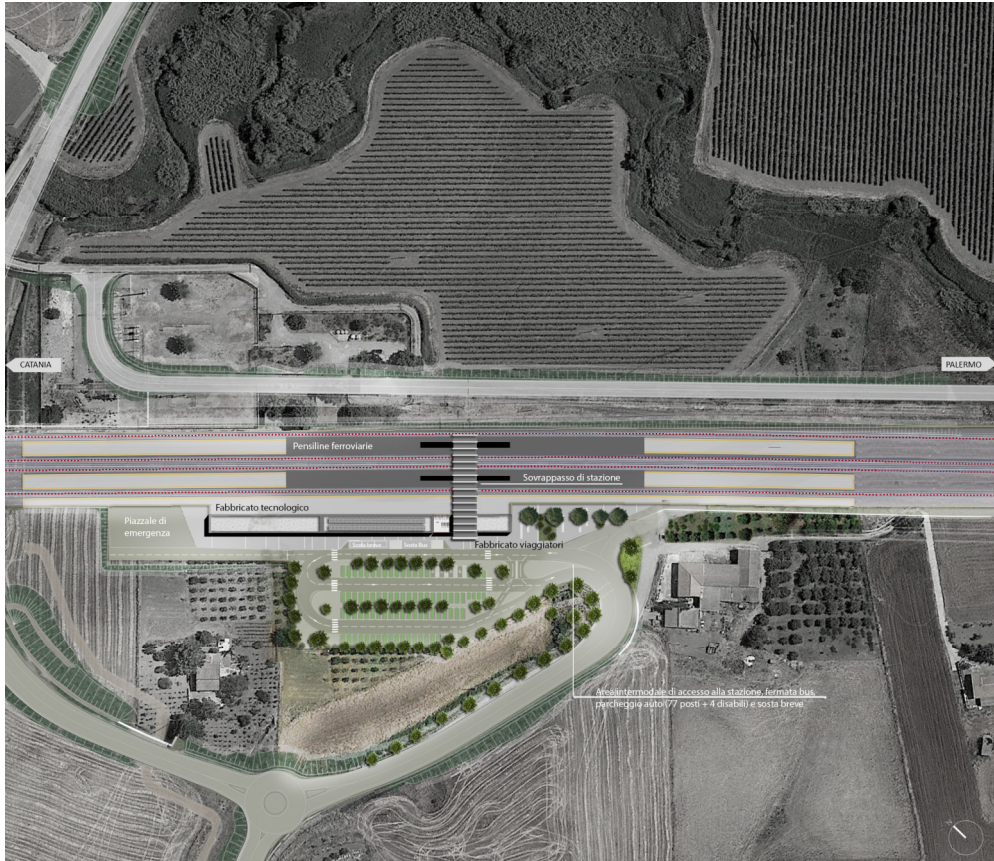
Planimetria generale della stazione di Vallelunga. Post Operam
